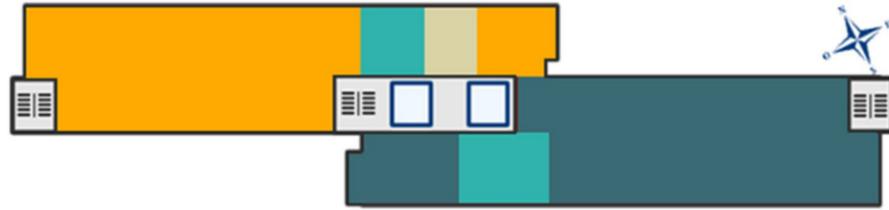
33 Zonificación planta 7. Fuente: Google
